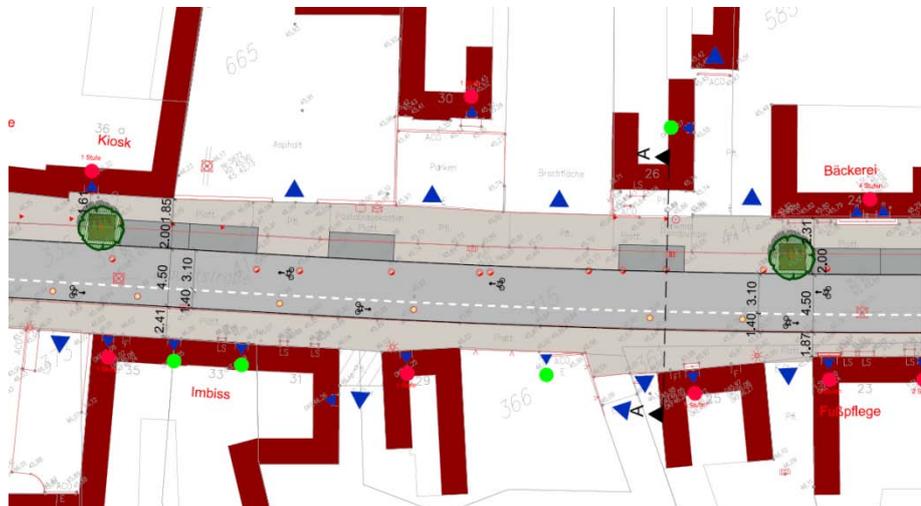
Ausschnitt aus dem Umgestaltungsplan Hauptstraße
